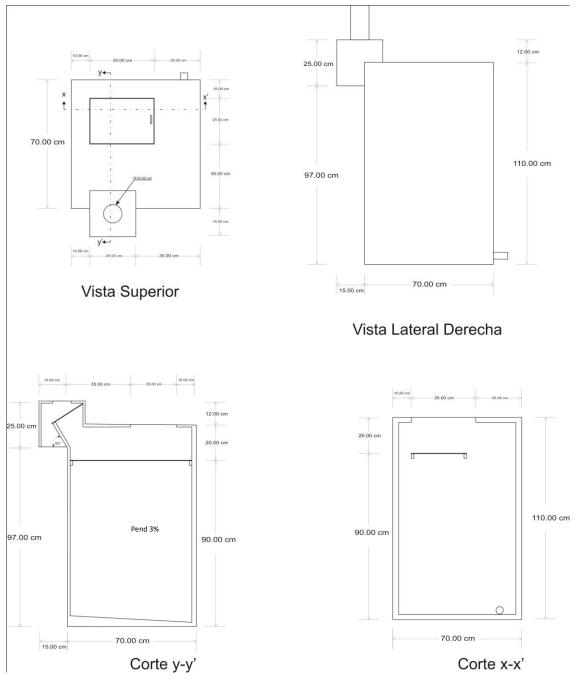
Plano del filtro. (Planos detallados en el ANEXO)
